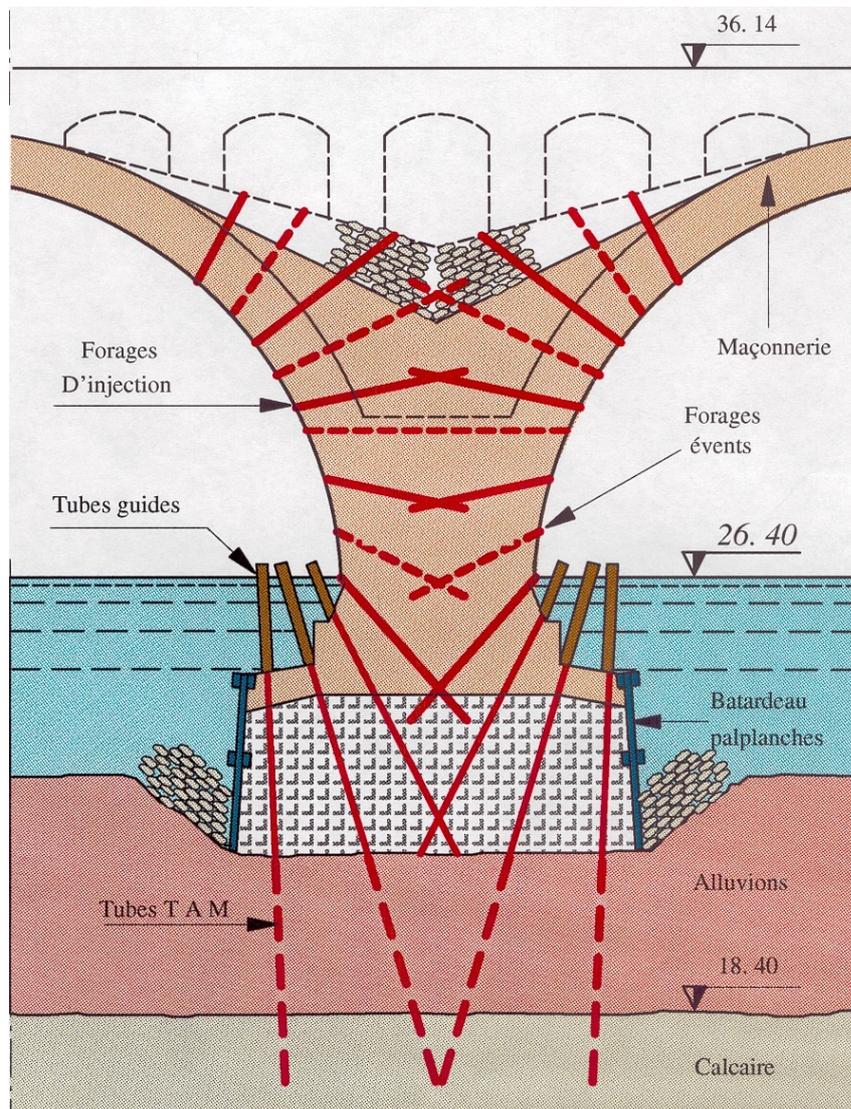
renforcement simultané du massif encaissant, des fondations et des maçonneries d'un pont (pont de Bercy – document Solétanche-Bachy).
